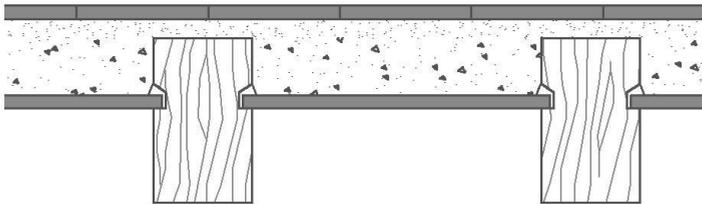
Forjado sanitario con vigas de madera - Fuente propia
